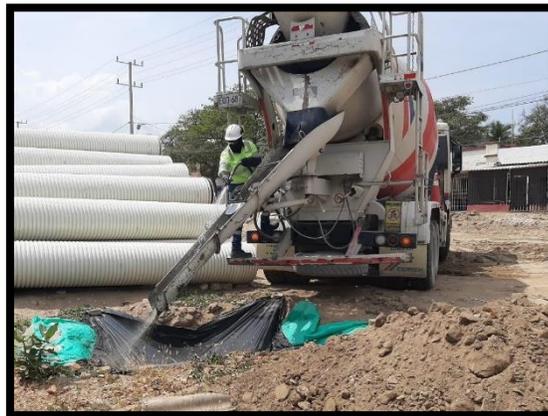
Lavado del mixer en sitio preparado para las aguas con residuo de concreto
